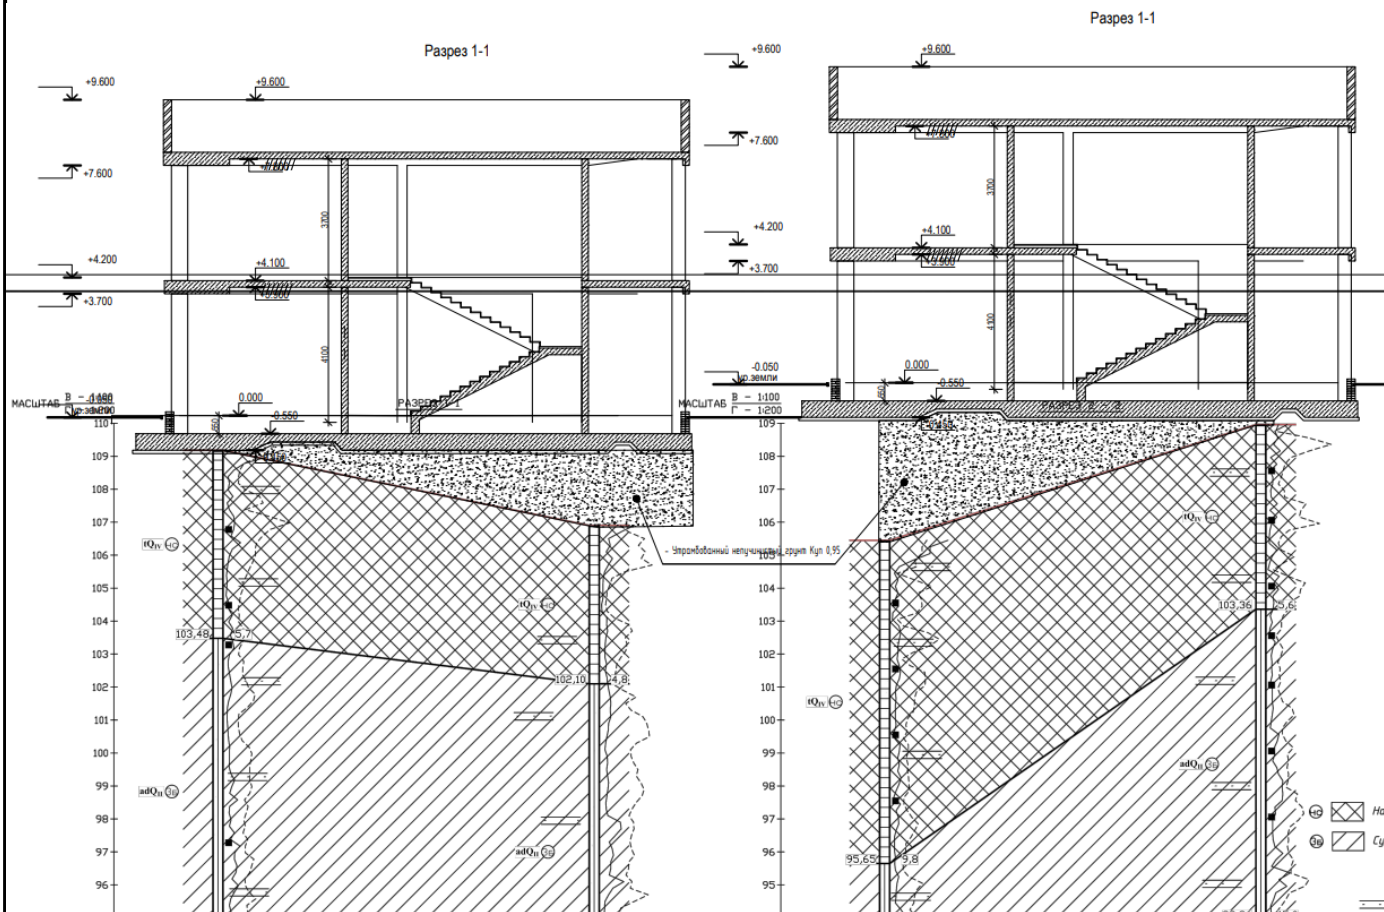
Инженерно-геологический разрез с посадкой фундамента здания
